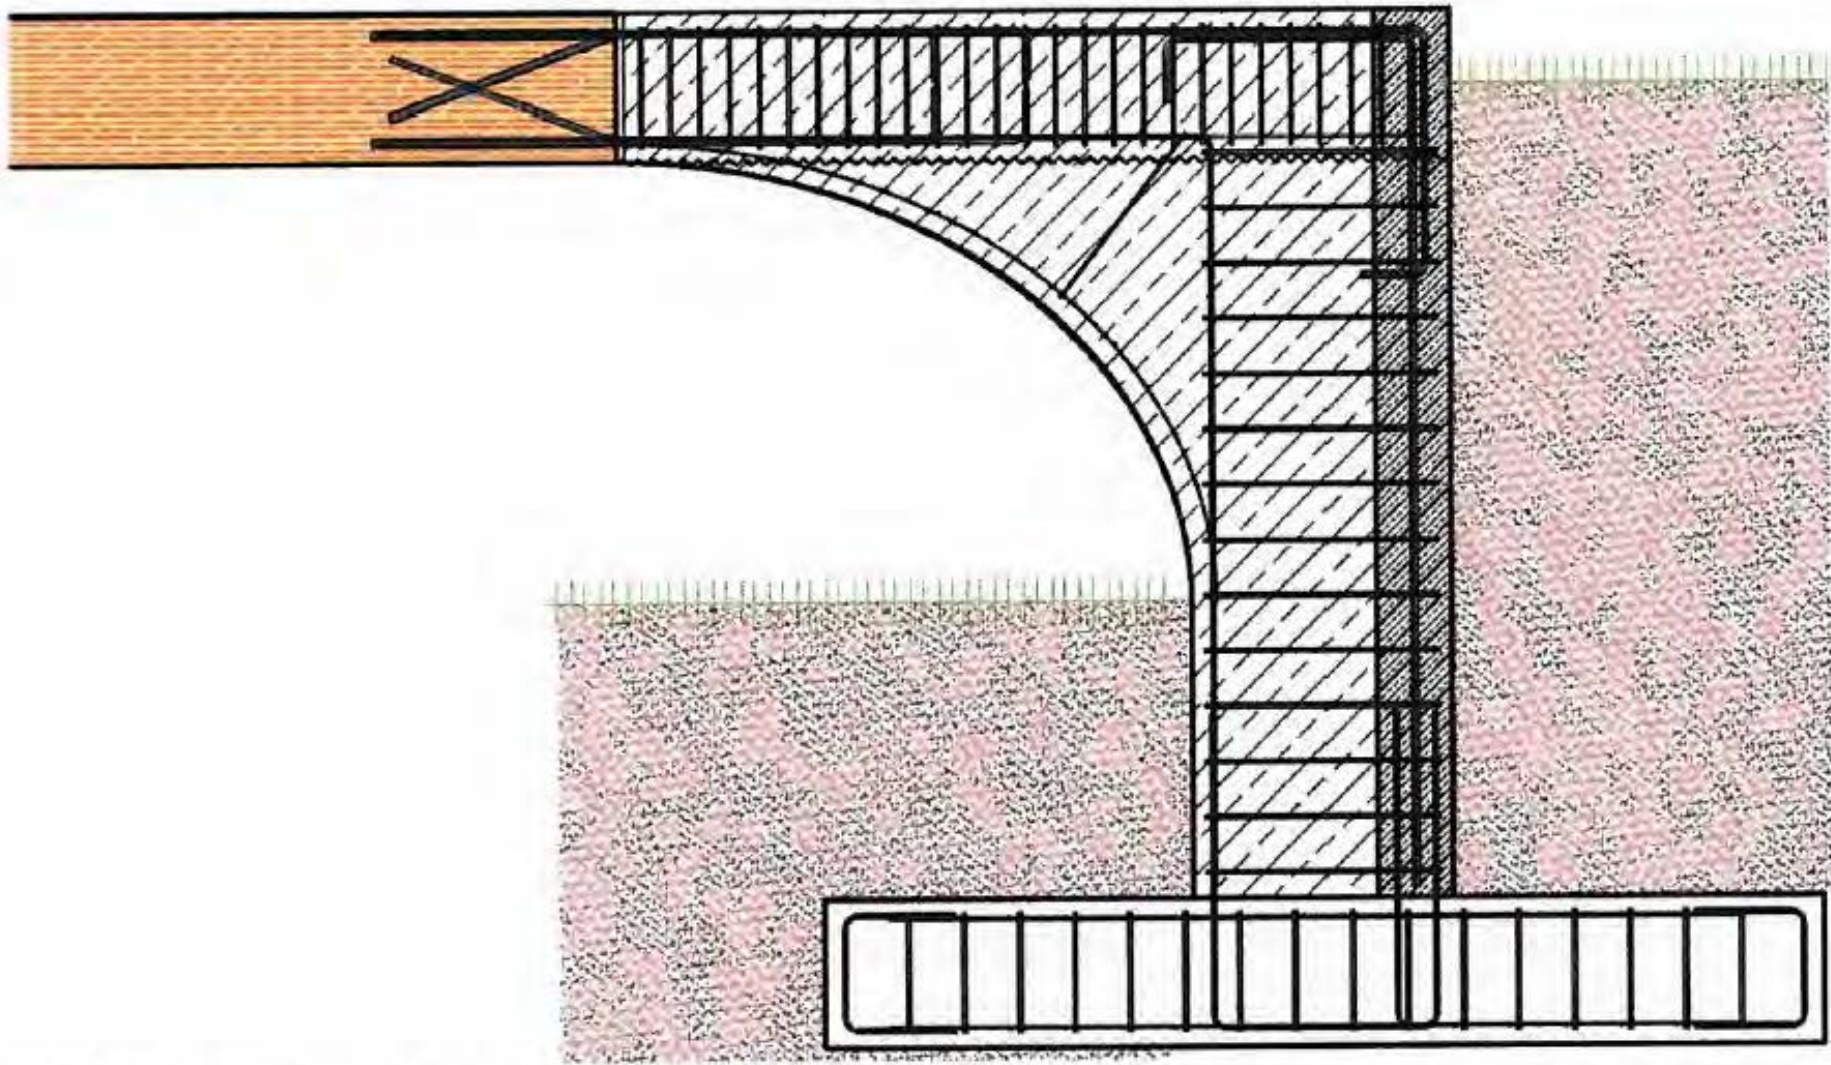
Schnittskizze des integralen Widerlagerbereichs der Stuttgarter Brücke mit schematischer Darstellung der Bewehrungsführung
